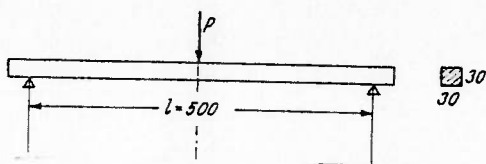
Viga utilizada por Gaube em ensaio de flexão
